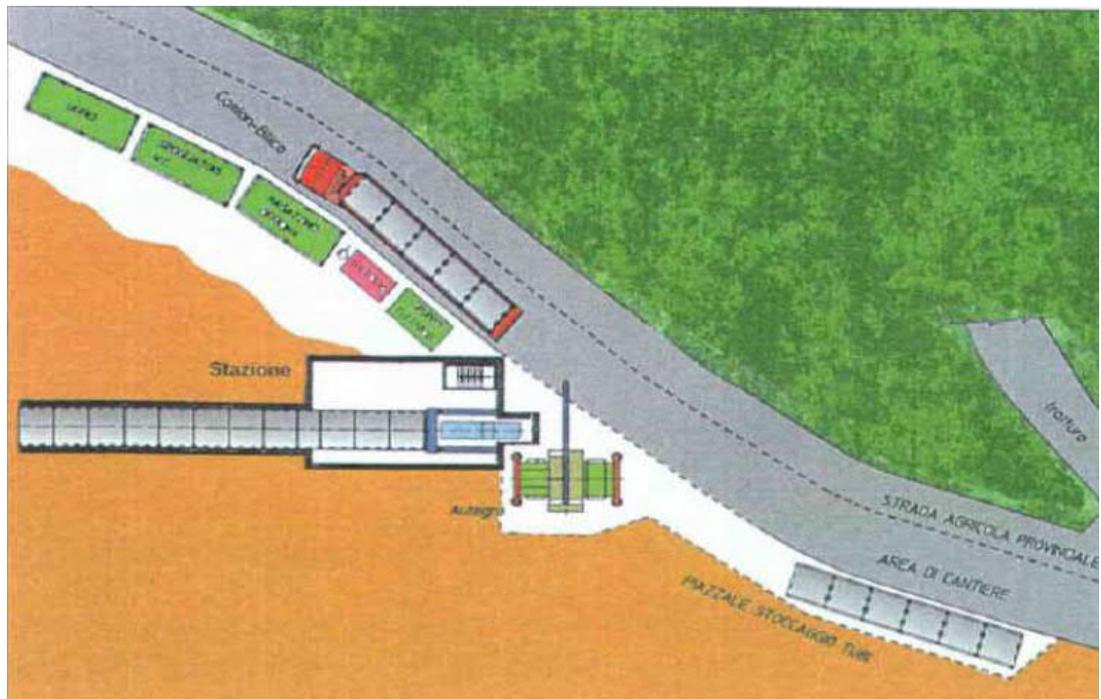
/Q – Schema tipo di un cantiere per l'installazione di un microtunnel
